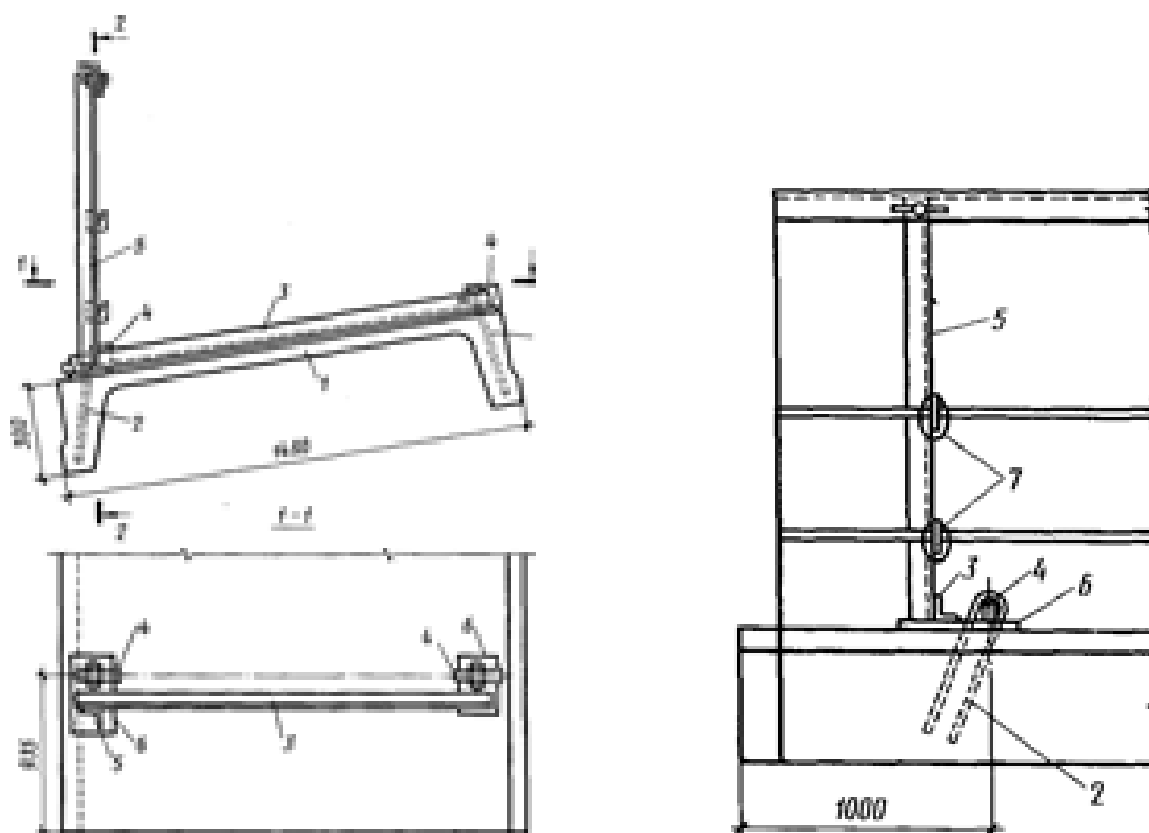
1 – залізобетонна плита; 2 – хомути;
